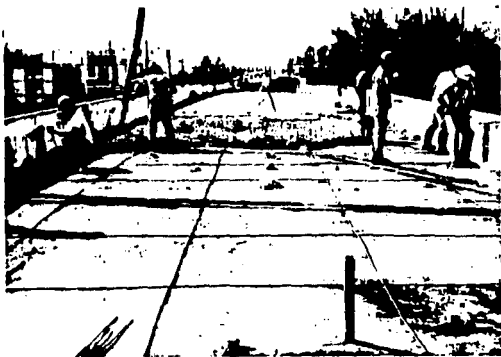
COLOCACION DEL CONCRETO EN EL
